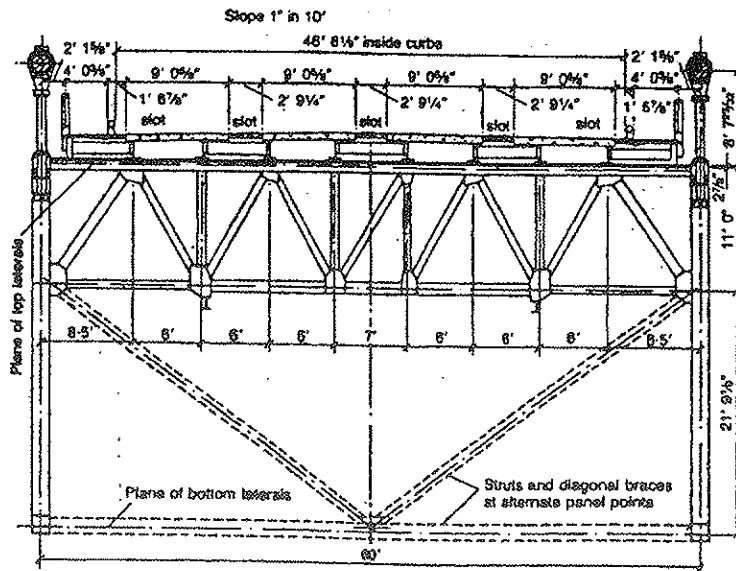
Sección transversal de la reconstrucción del puente de Tacoma.
